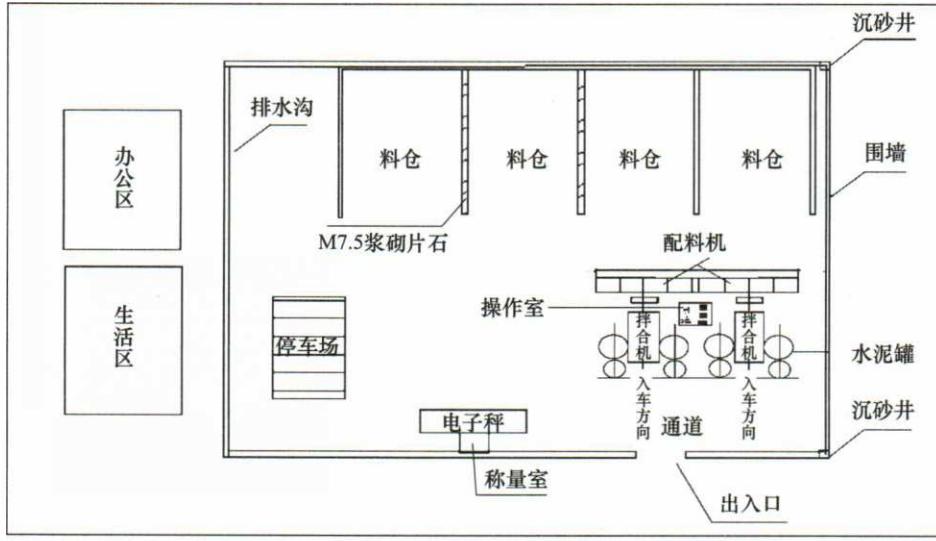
某水泥混凝土拌合站平面布置示意图
